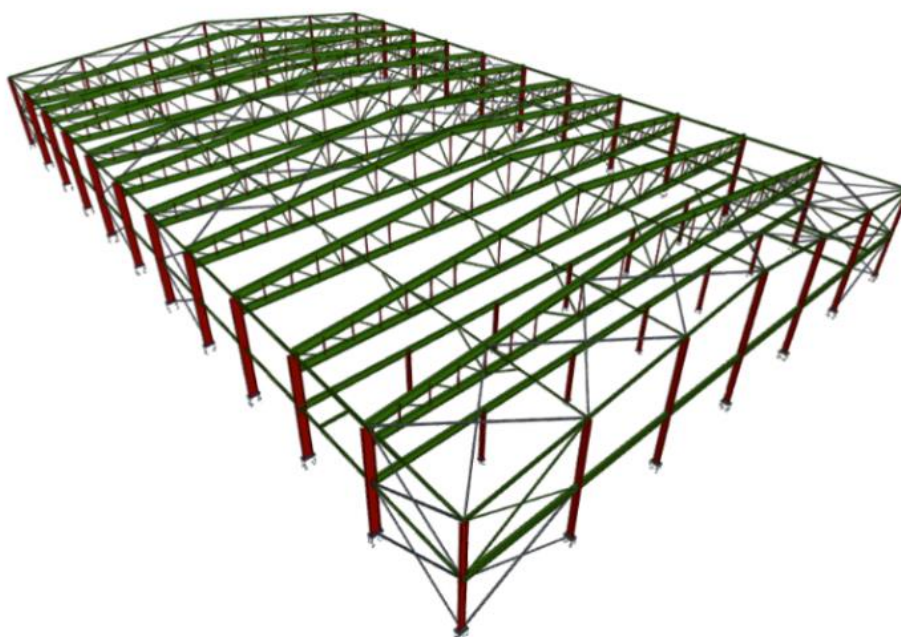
Estructura 3D de la edificación (Fuente propia)
